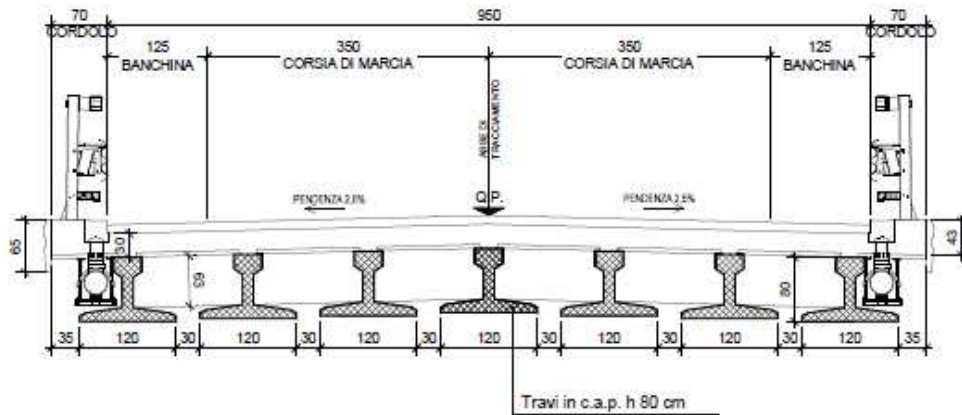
Sezione impalcato Ponte sulla Derivazione Santa Bianca
